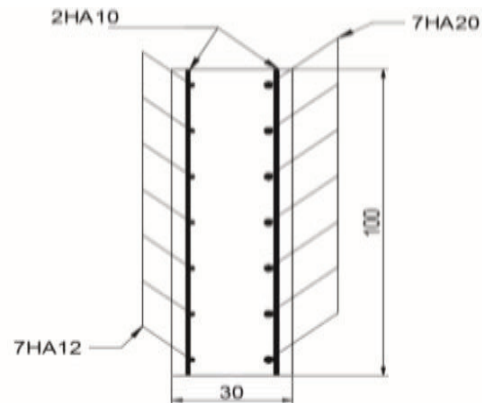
Vue en plan du ferrailage de mur garde grève
